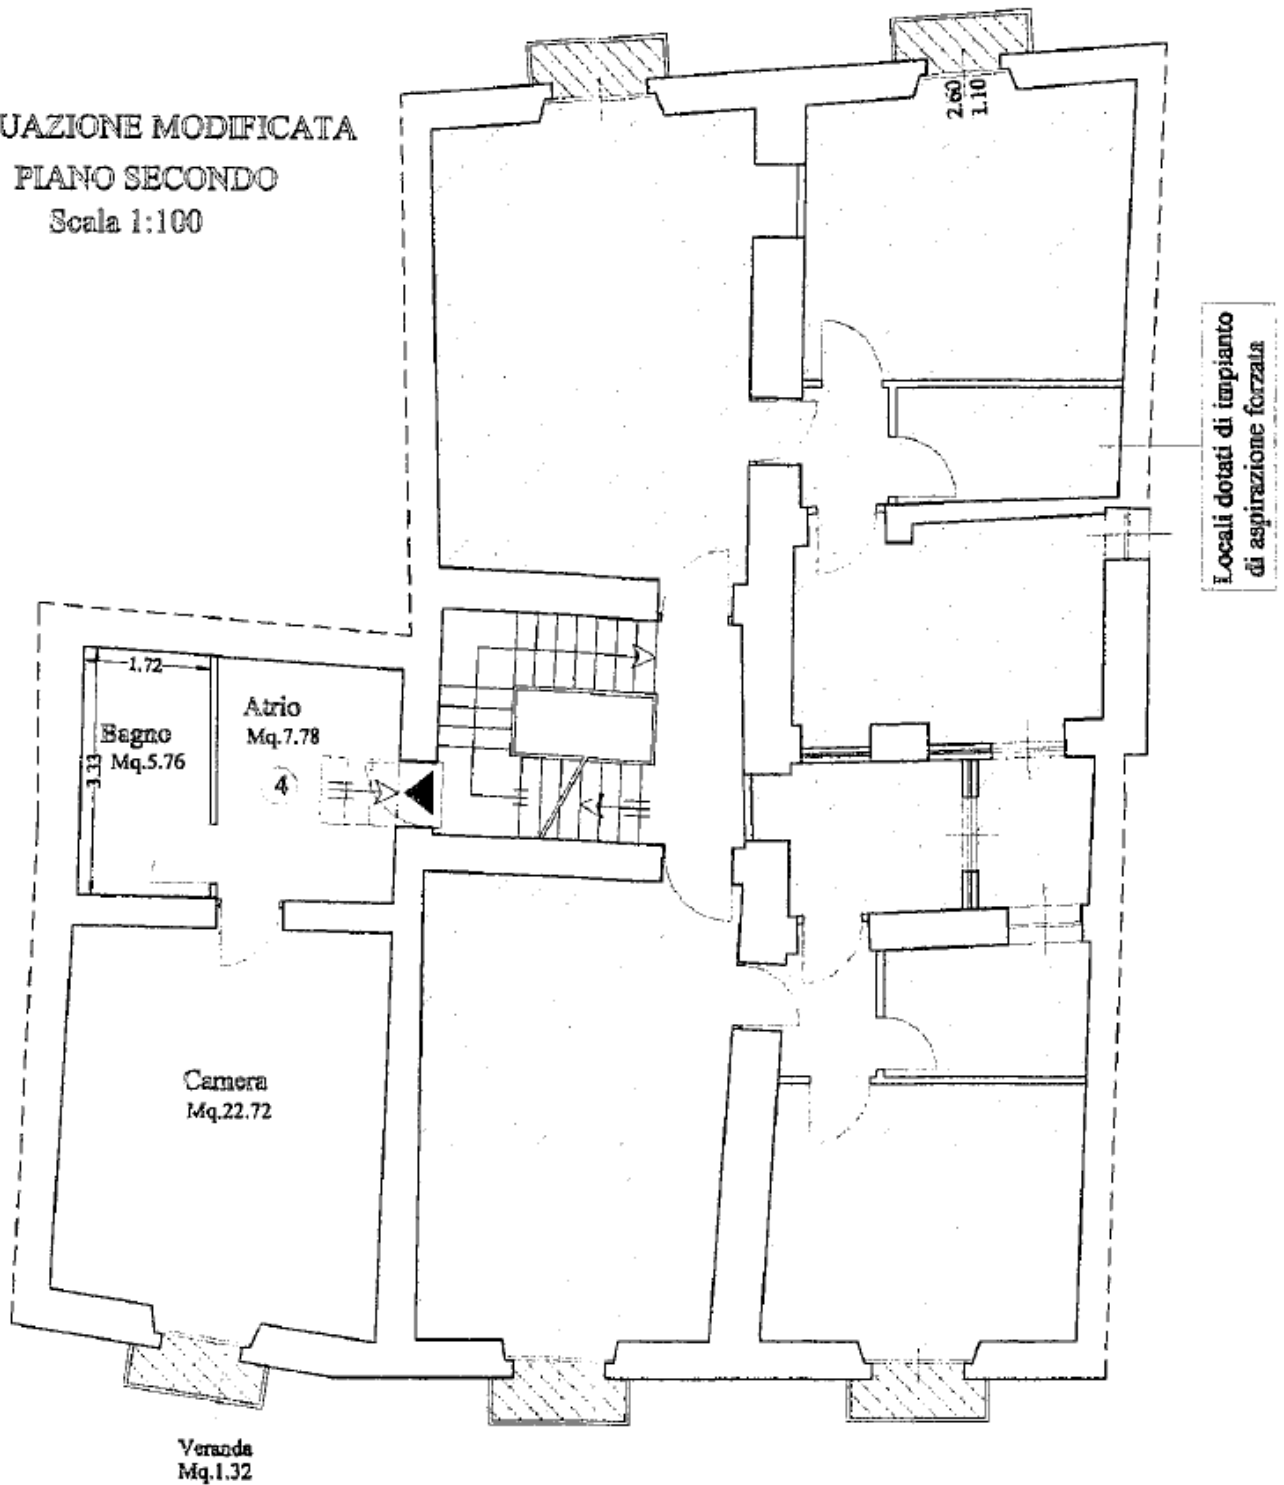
Stralcio dell'ultimo progetto approvato. Aut. Ed. n. 105/2007 (fuori scala). Secondo Piano
